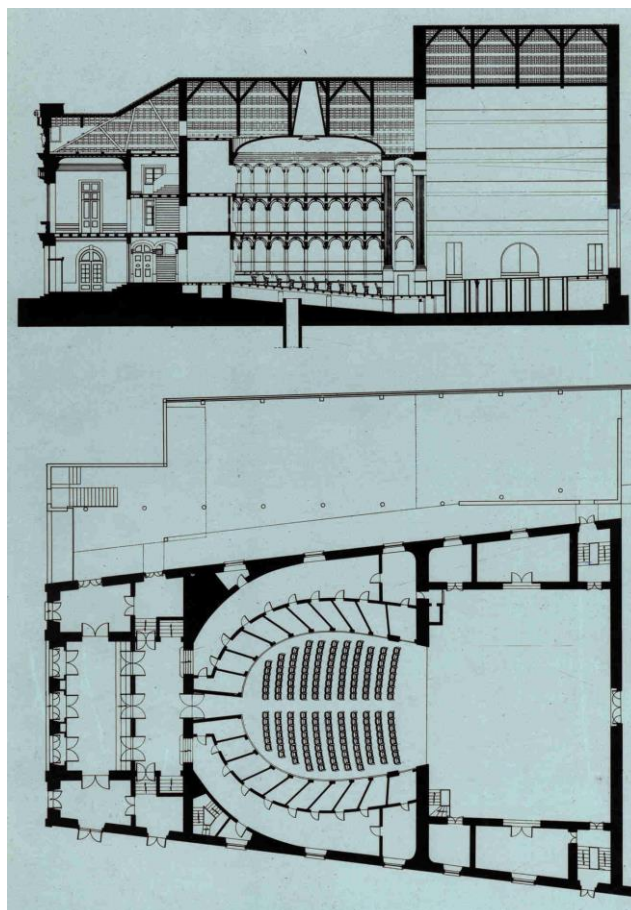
Planta y alzado del Teatro Sá de Miranda en Évora. Imagen facilitada por el Teatro Municipal Sá de Miranda.
